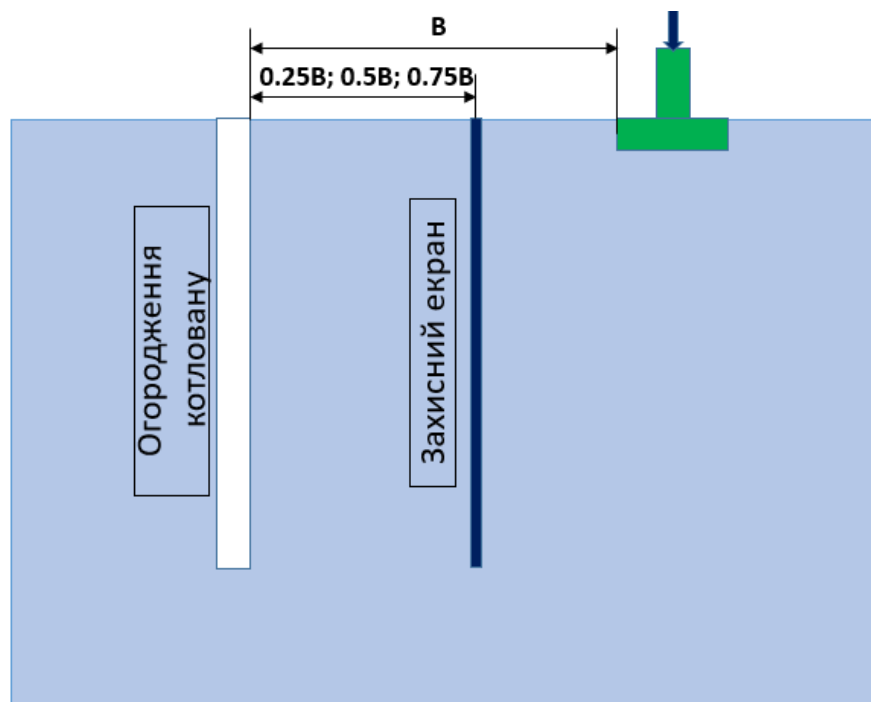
Розрахункова схема при дослідженні впливу положення захисного екрану між огорожуючими конструкціями котловану та існуючою будівлею
